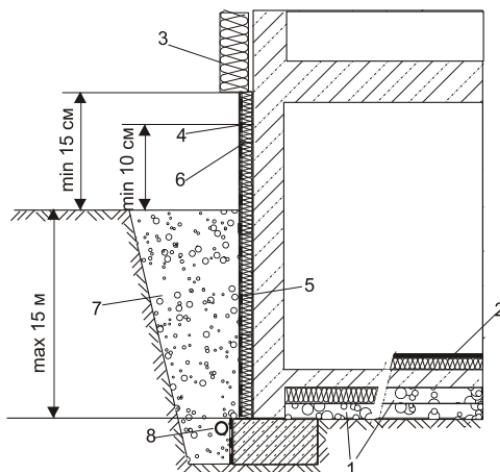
Утепление внешних стен фундамента с подвальным помещением: 1 — щебеночная подготовка; 2 — конструкция пола; 3 — утепление наружной стены; 4, 5 — утеплитель; 6 — гидроизоляция; 7 — кольцевой дренаж (трубы перфорированные); 8 — песочно-гравийная смесь или песок
